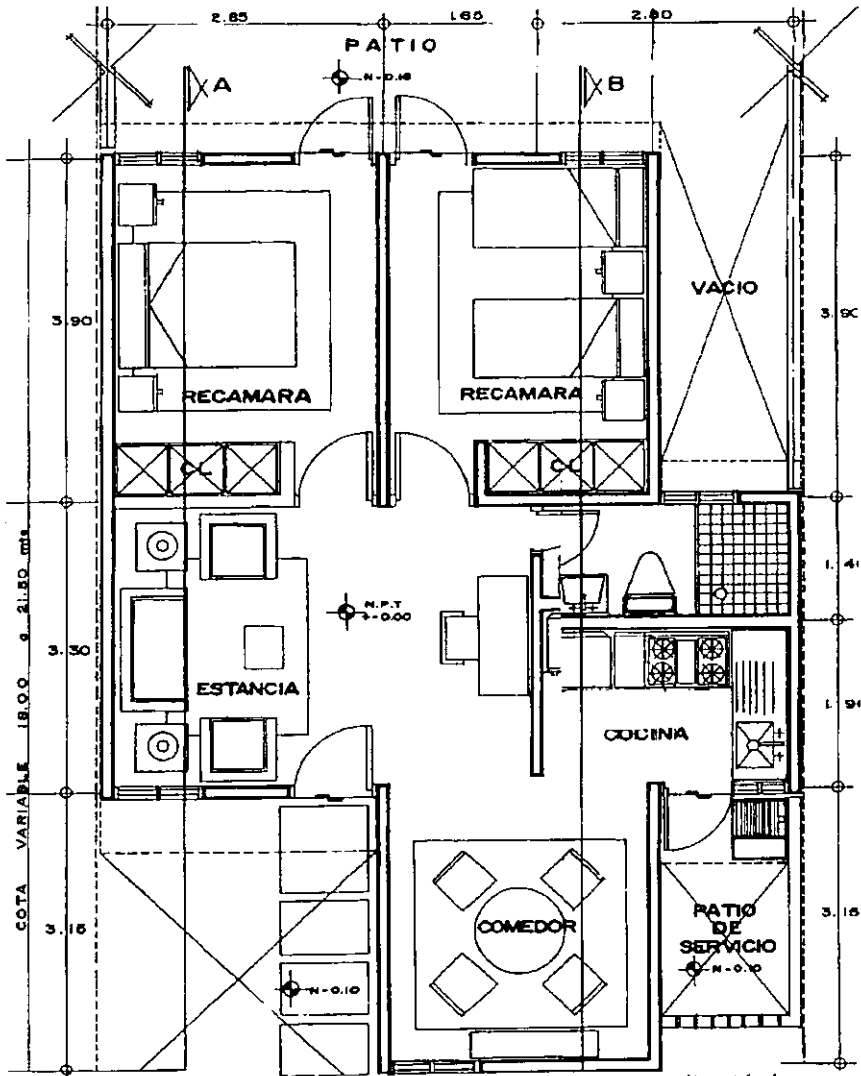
S. D. T. E. V. Coscomatepec; planta arquitectónica.
